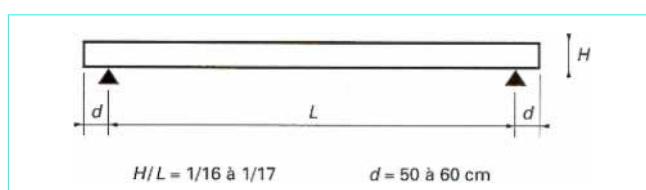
Élançement des ponts à poutres précontraintes par pré-tension
